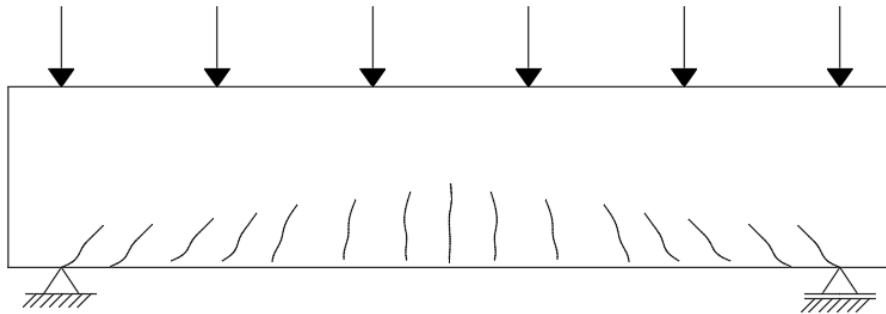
Configuração típica de fissuras em viga biapoiada solicitada à flexão. Fonte: adaptada de Thomaz (2012)
